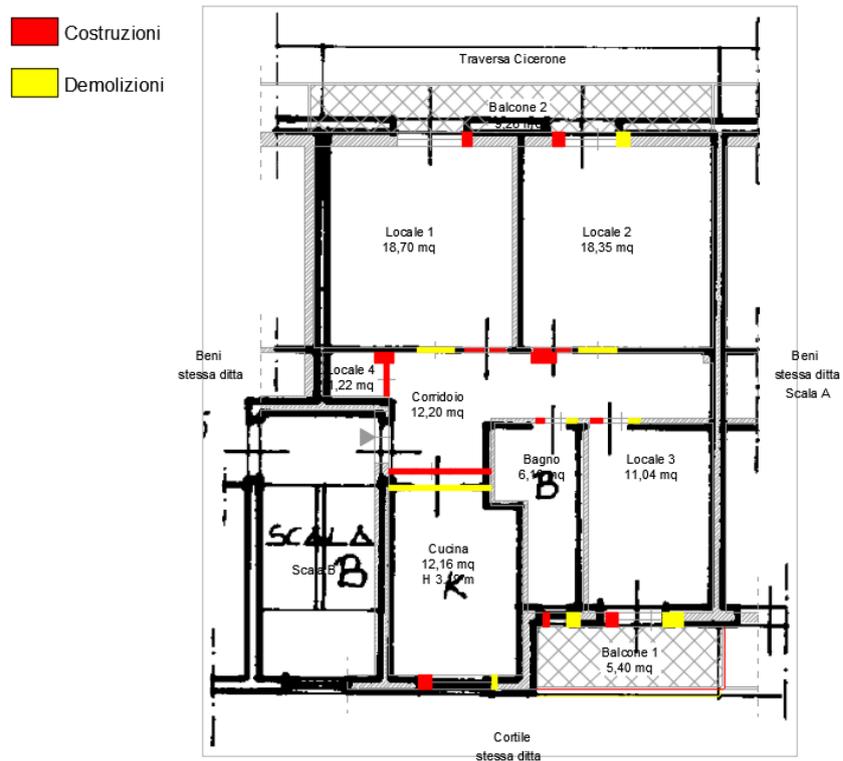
Confronto con planimetria catastale (Foglio 4, p.la 1225, sub. 12)
